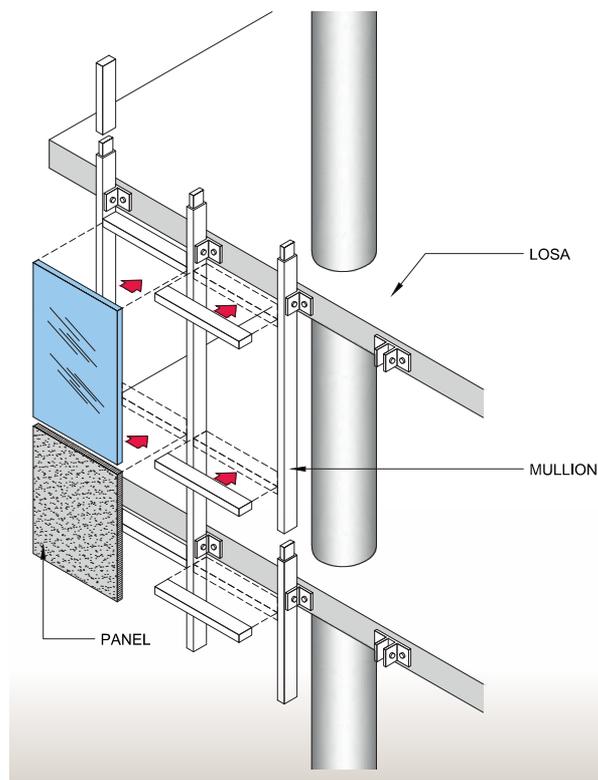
Secuencia de instalación de muro cortina con sistema stick.
